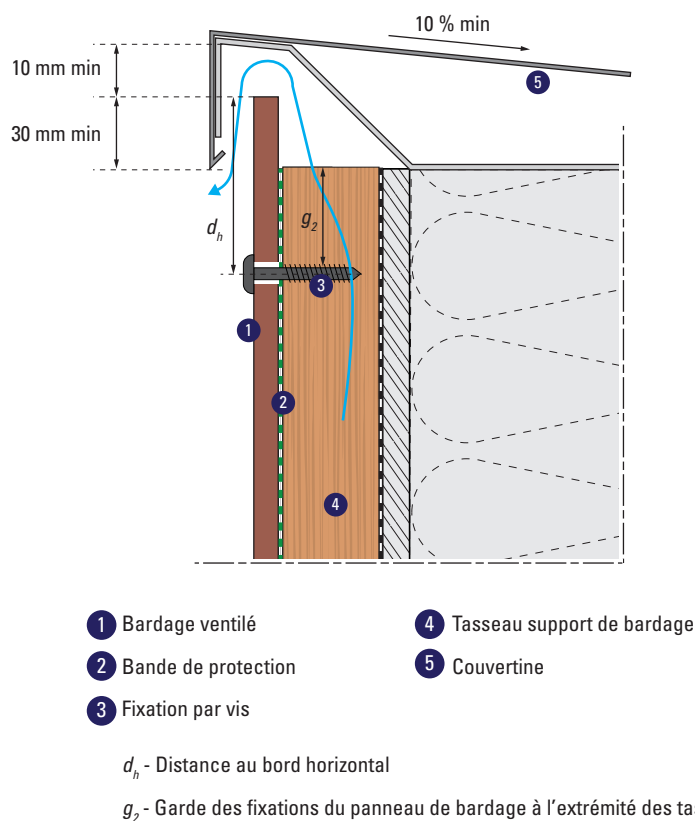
Exemple de traitement d'un arrêt de bardage sur acrotère - coupe verticale
